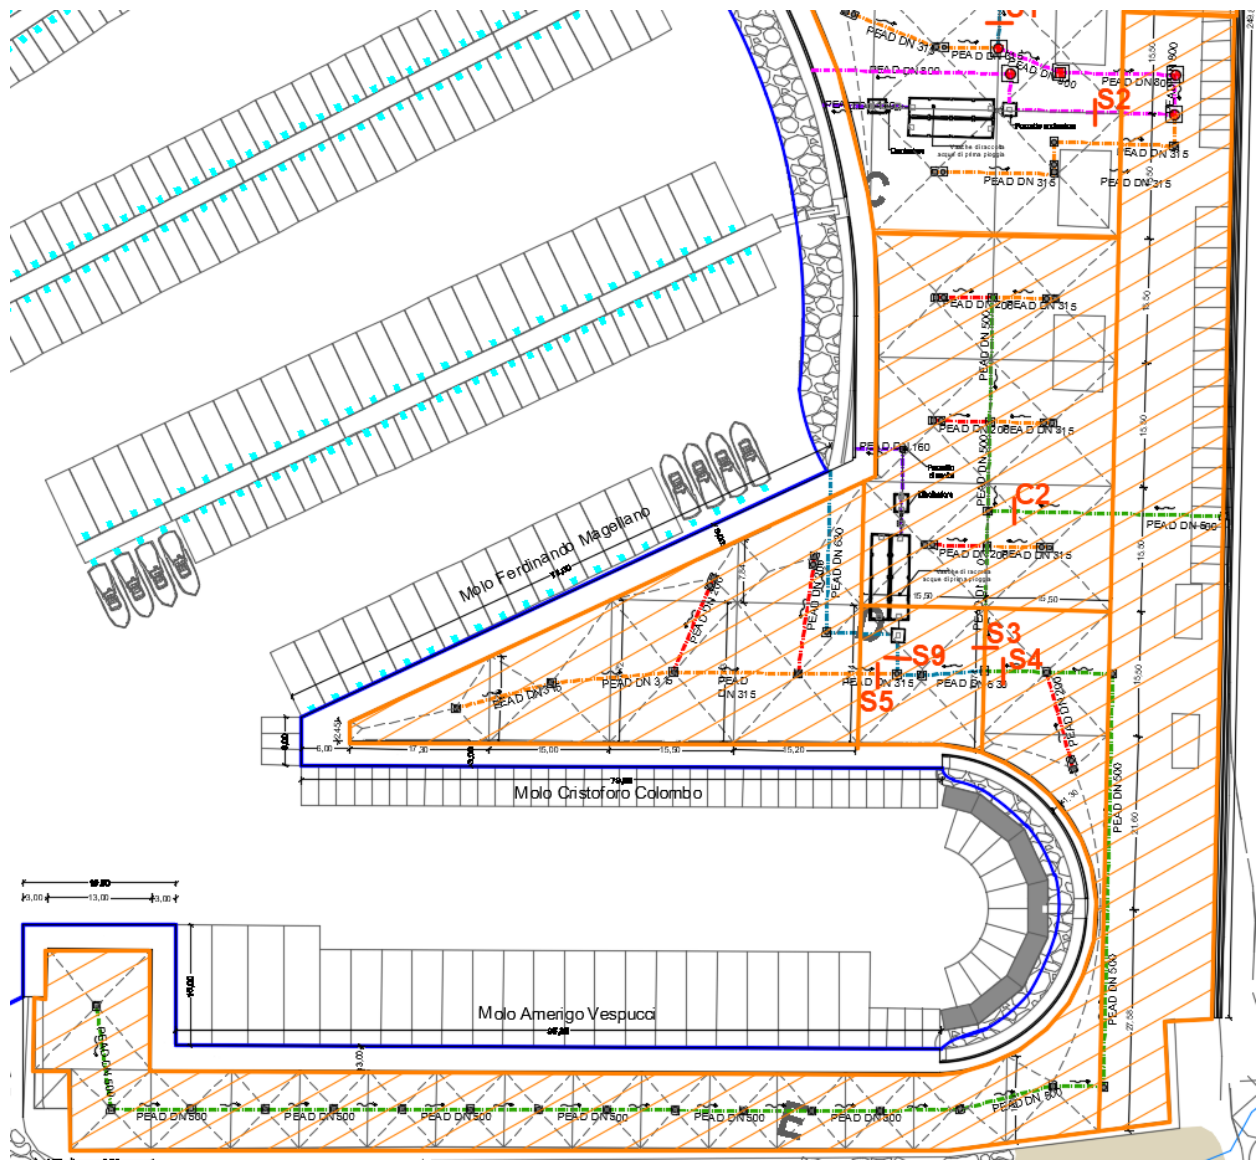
Planimetria con indicazione aree scolanti e sezioni di controllo impianto 2
